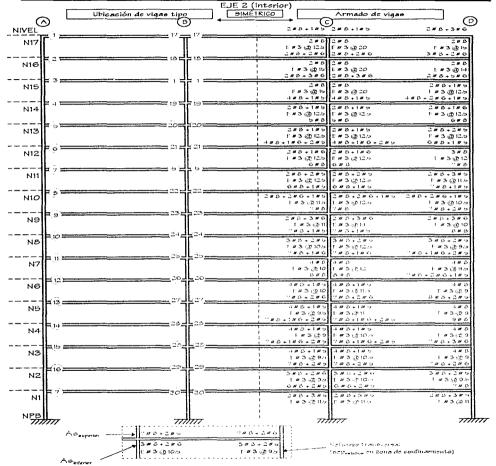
Uticación de los tipos de armados de las vigas del eje 2 de la estructura de 17 niveles discñada en la zona il
